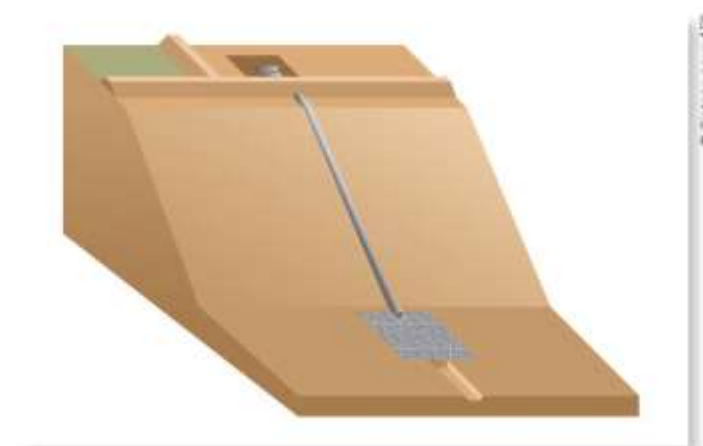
Schéma de principe d'installation d'un drain de pente sur une surface décapée pentue.
